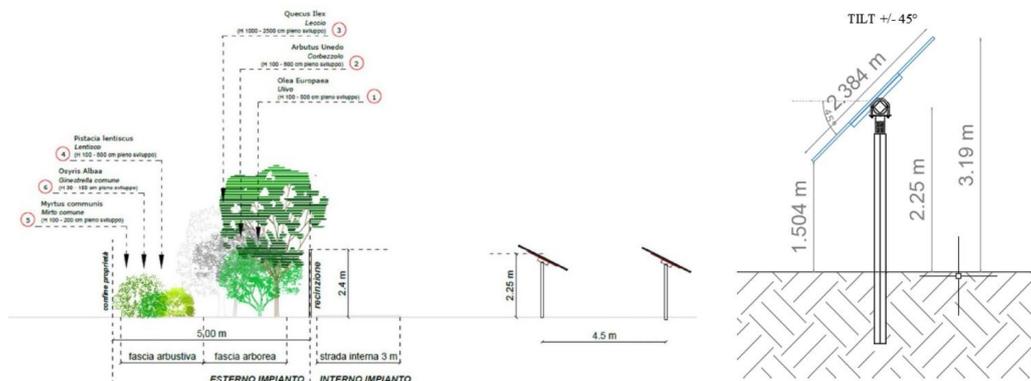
Stralcio sezione longitudinale opere mitigazione - TAVPROG008
